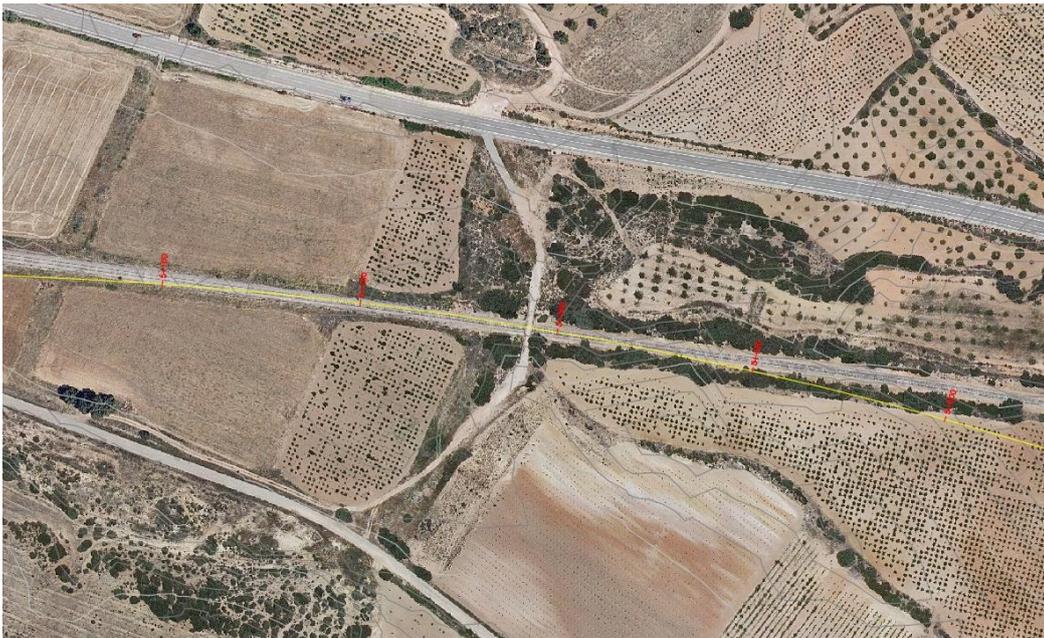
Paso elevado P.K. 5+344 (5+285 del trazado modificado).
